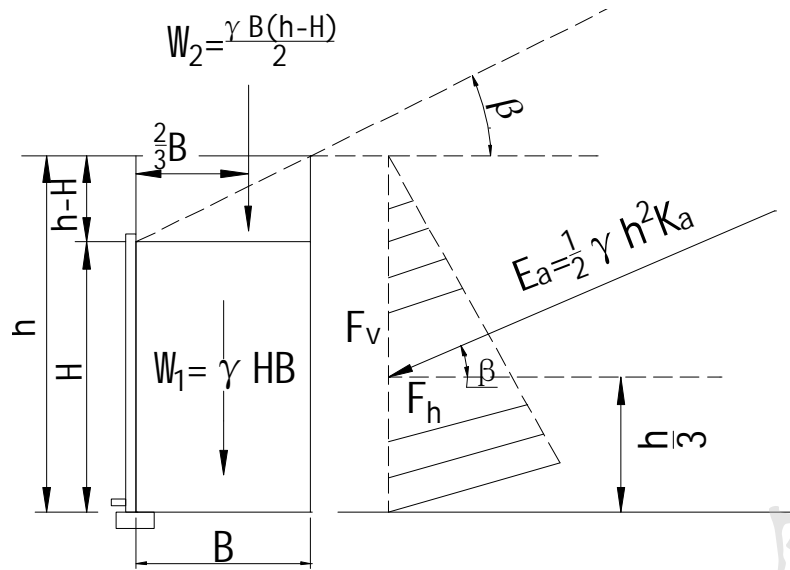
墙背垂直、填土面倾斜时的土压力计算
